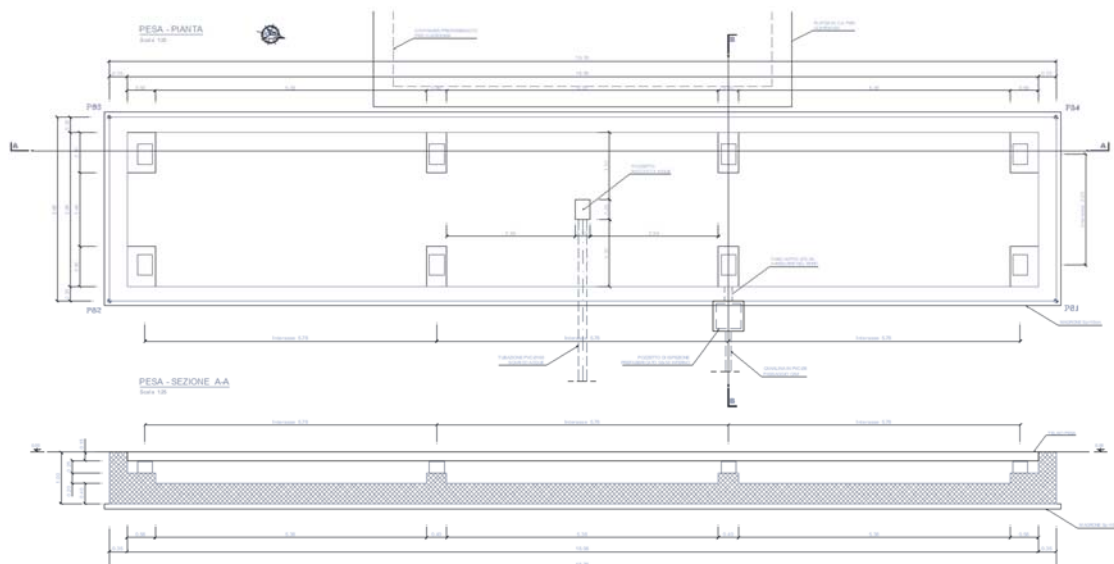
PIANTE E SEZIONE LONGITUDINALE
